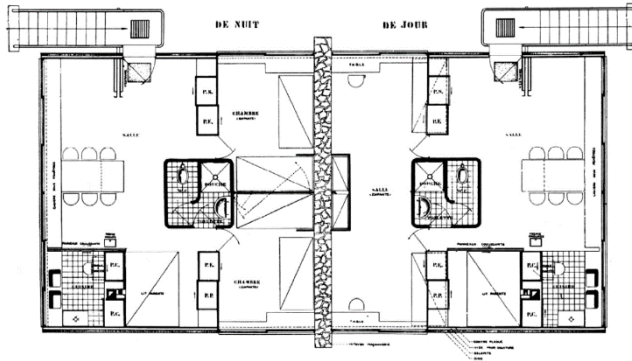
Le Corbusier y Pierre Jeanneret Planta tipo, Maison Loucheur, 1929
